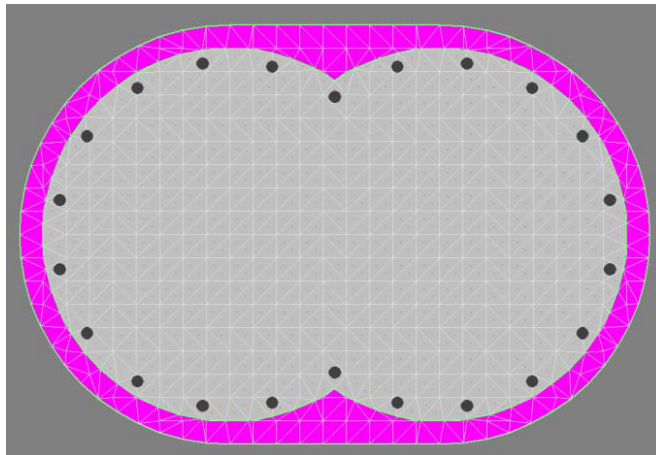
Refuerzo longitudinal en el lado derecho.
